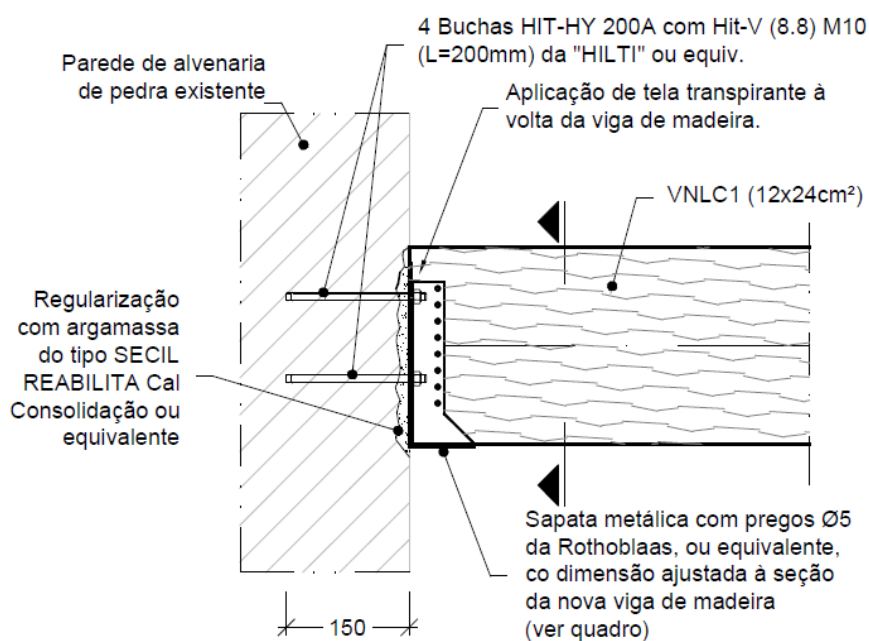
Alçado do pormenor de ligação de viga de madeira com parede de alvenaria através de sapata metálica (NCREP, 2018)
